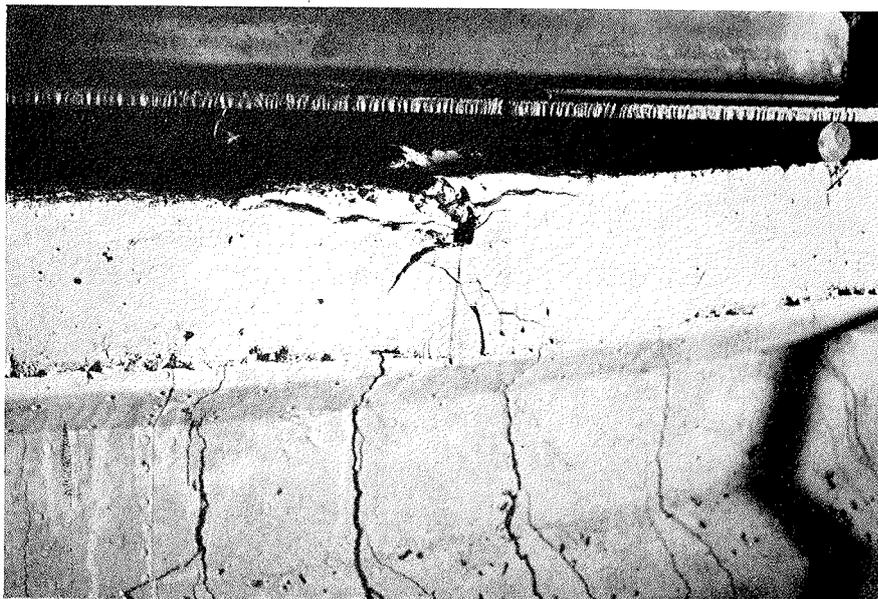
Detalle del inicio de la rotura de la losa en la viga tipo D.
